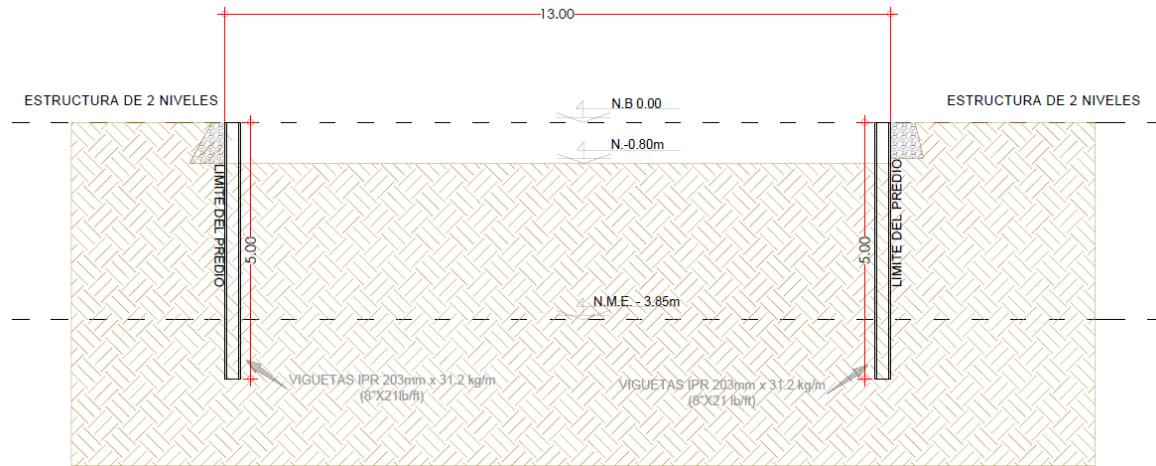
COLOCACIÓN DE VIGUETAS METÁLICAS IPR 8” x 21lb/ft
